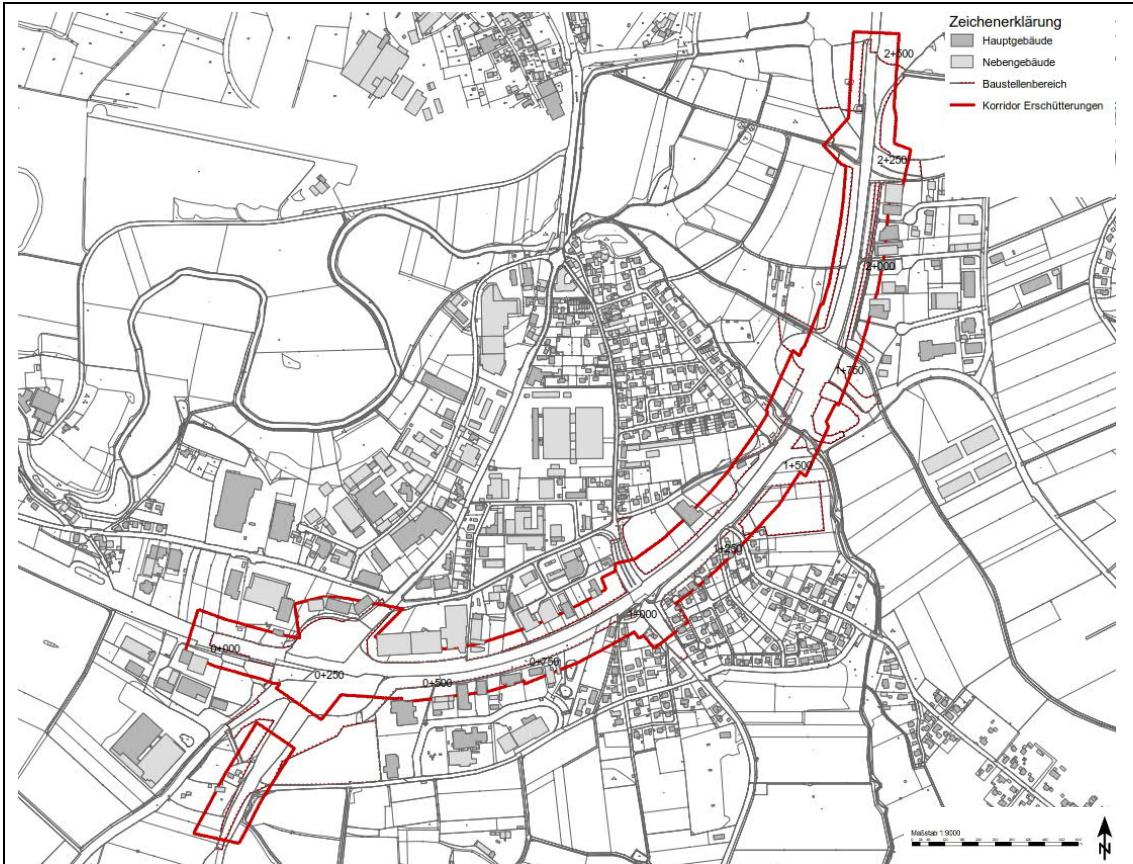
Übersichtslageplan Betroffenheiten durch Bauerschütterungen
